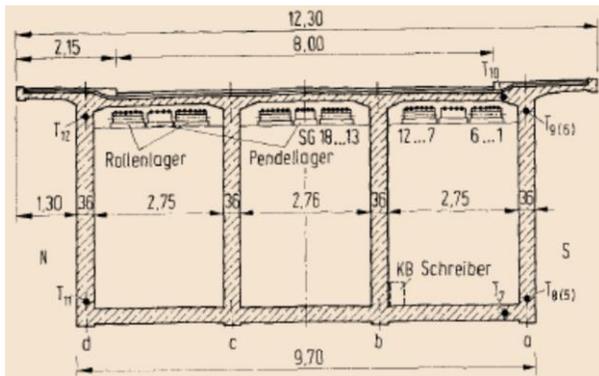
Querschnitte durch den Kragträger mit Lagerung der Spannlieder [4, S.154 Bild 13]
